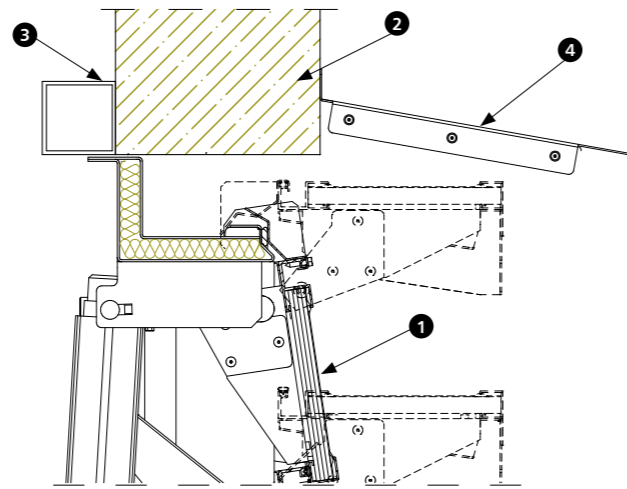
Montage des Lamellenlüfters in der Wand (Fassade) zum tragenden Stahlprofil, z.B. Auswechslung, Pfette
